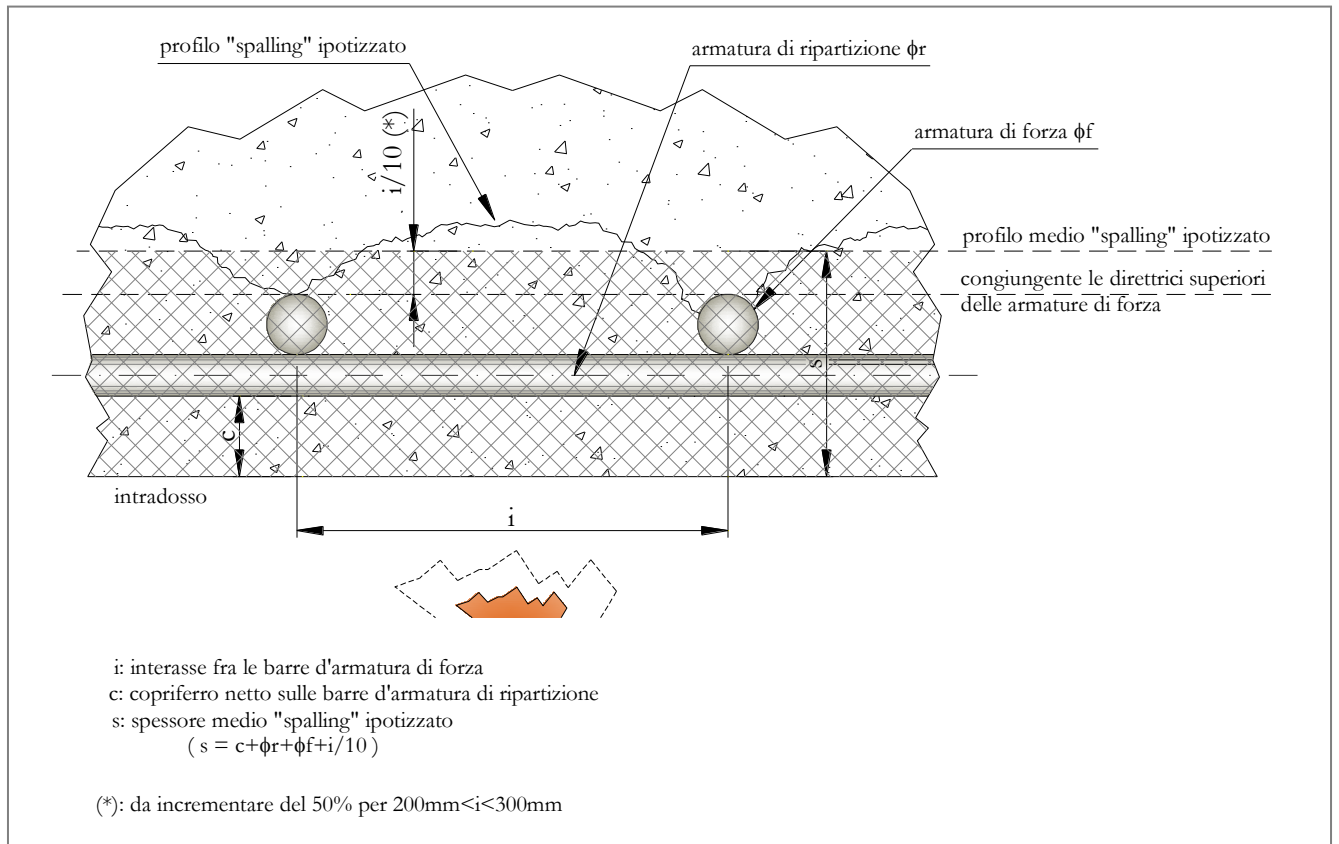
Stralcio schematico sezione strutturale per quantificazione fenomeno "spalling" da cfr. rif. [11]
